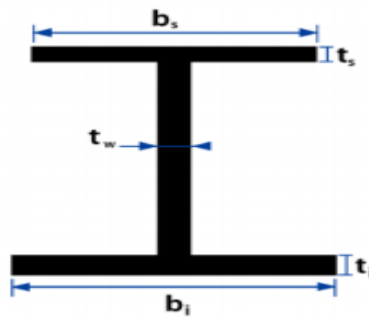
les dimensions transversales de la poutre métallique [3].
